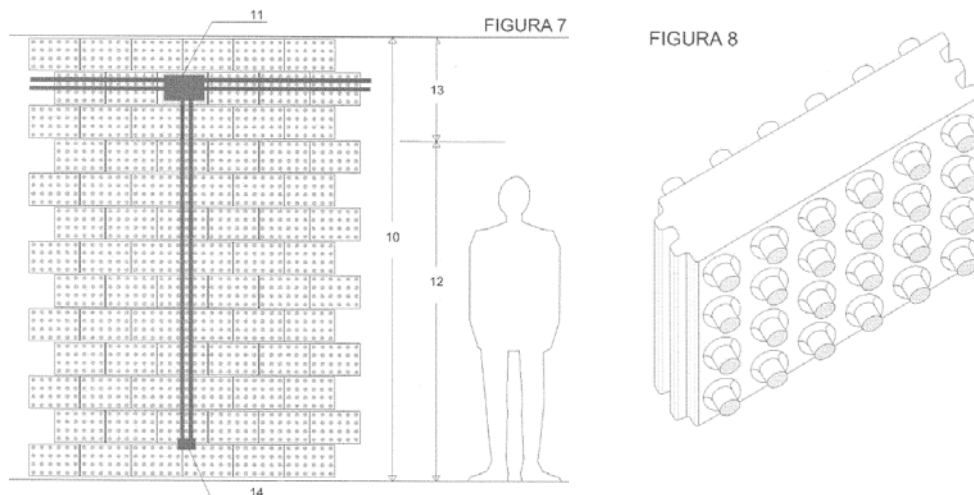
Patente de Rafal García Quesada, para ladrillo prensado.
